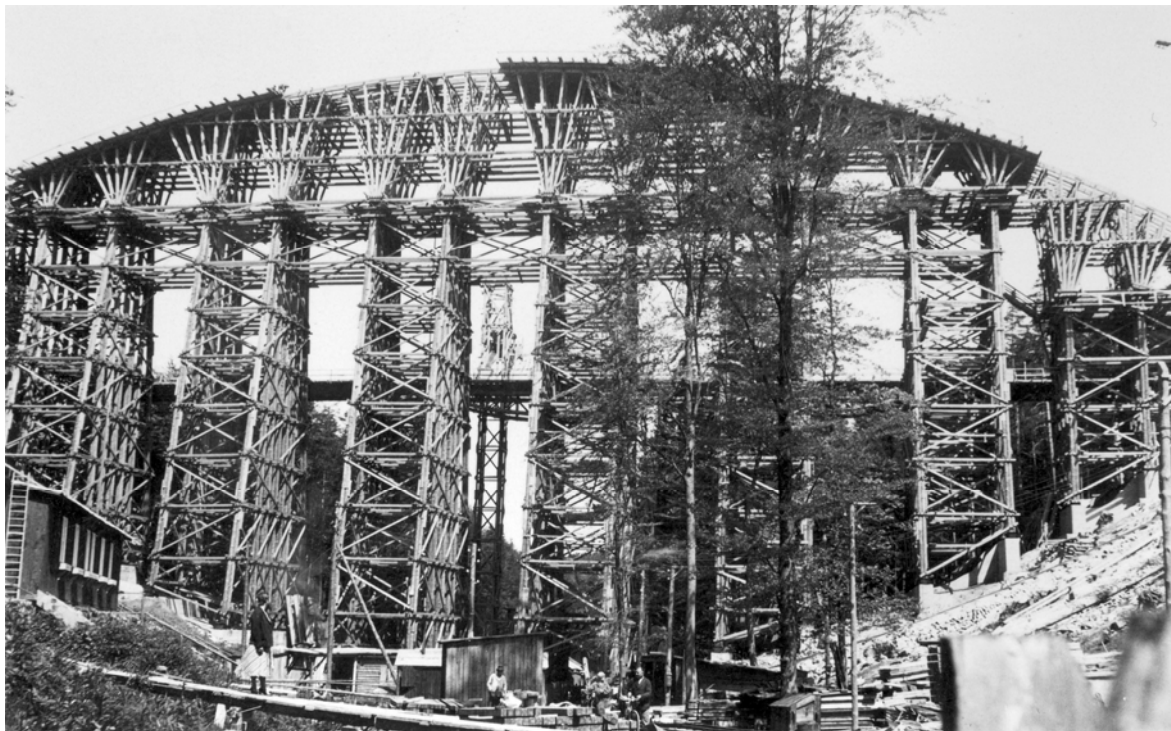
Lehrgerüst von 1938: 1400 m³ Holz
